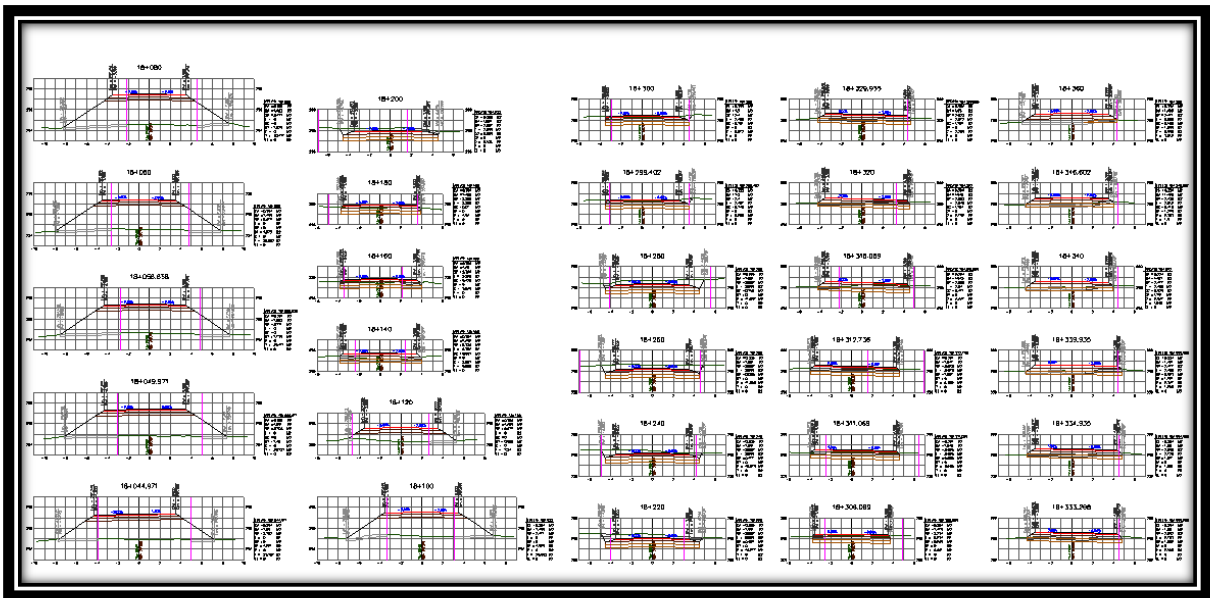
Secciones de construcción del km 18+044.971 al km 18+360.000.
